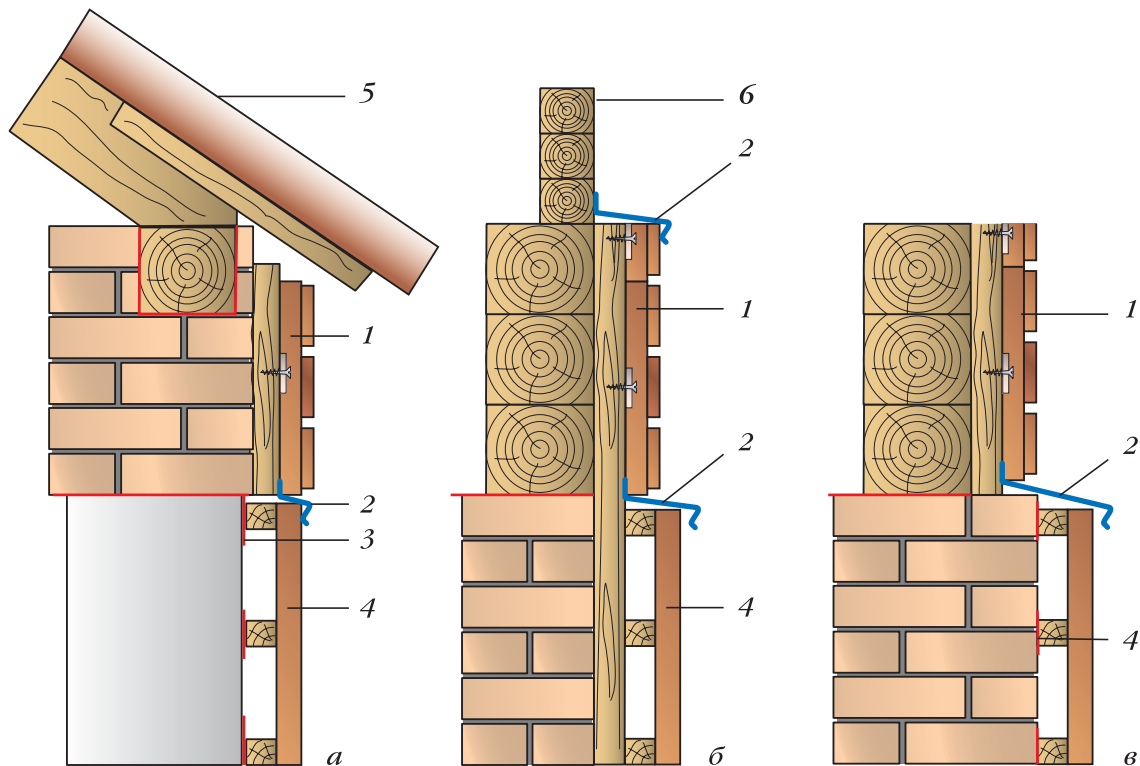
Облицовка цоколей, устройство примыканий облицовок с обеспечением вентилируемого продуха: а — западающий цоколь и карниз крыши; б — ровный цоколь и фронтон крыши; в — выступающий цоколь; 1 — рядовая облицовочная панель; 2 — отлив; 3 — гидроизоляция; 4 — цокольная панель; 5 — крыша (карниз крыши); 6 — фронтон
